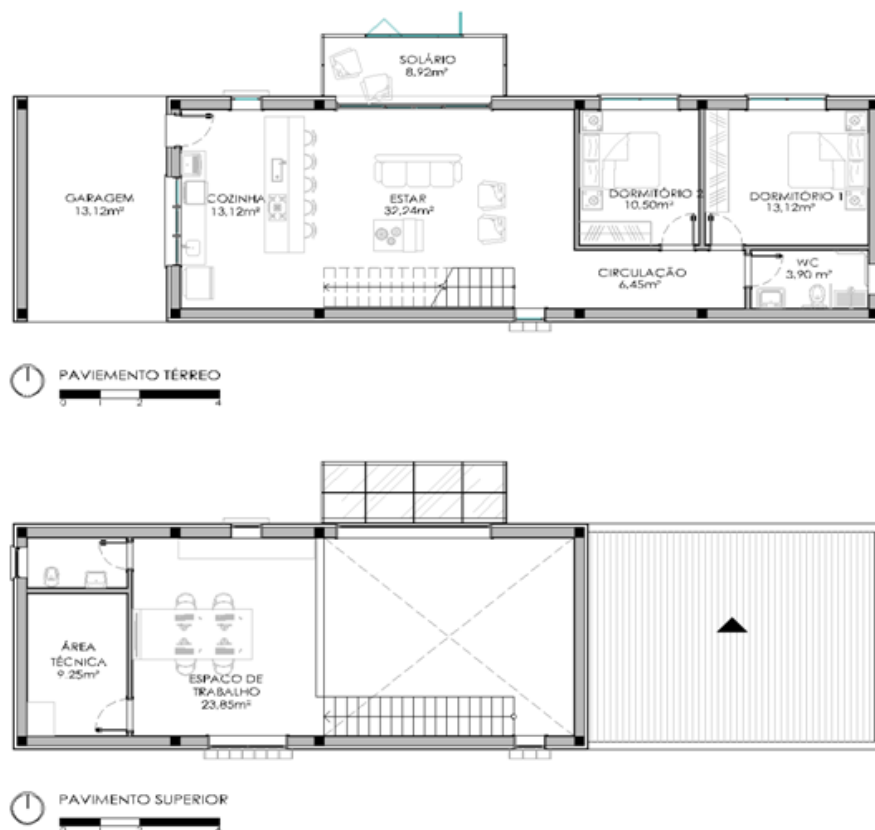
Planta Baixa Pavimento Térreo e Superior (DALBEM, 2015).
